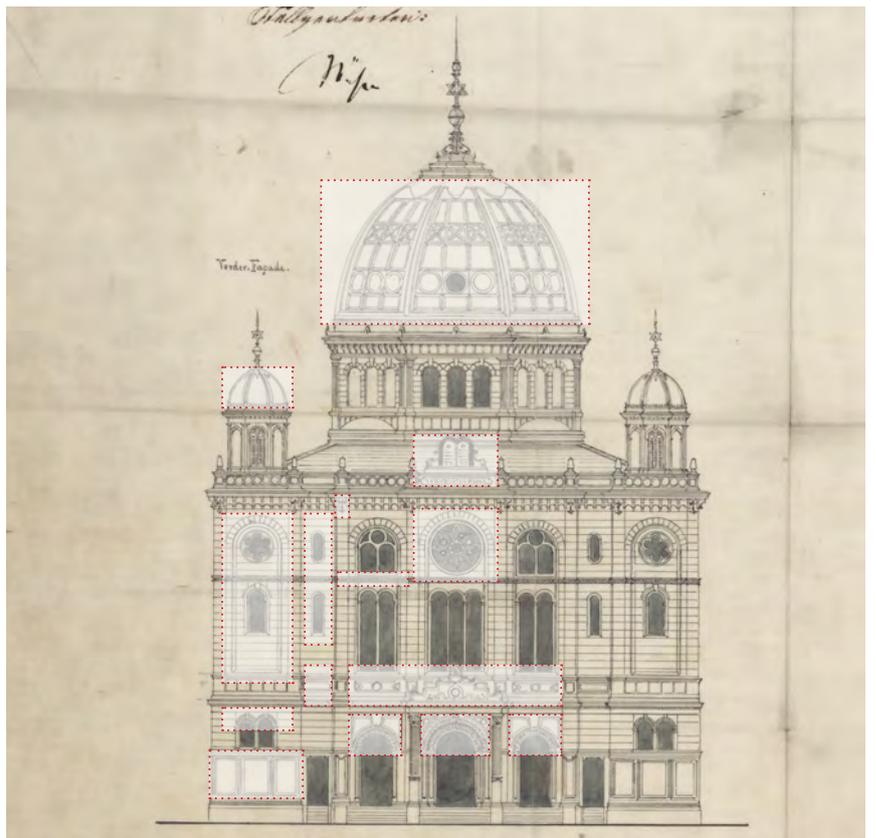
Vergleich zwischen Einreichplan, 1880 und Ausführung
